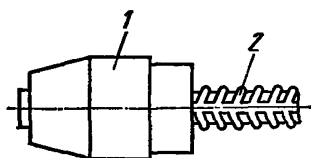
Зажим С3-16-25 для закрепления арматуры: 1 — корпус, 2 — арматурный стержень
